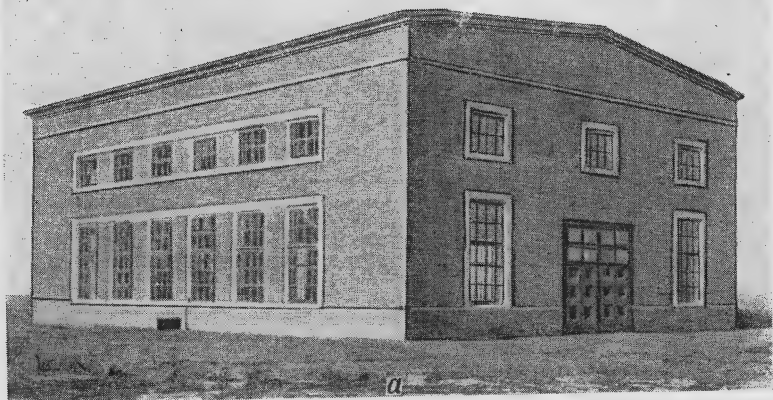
Промышленное здание с металлическим каркасом, находившееся в зоне полного разрушения:
